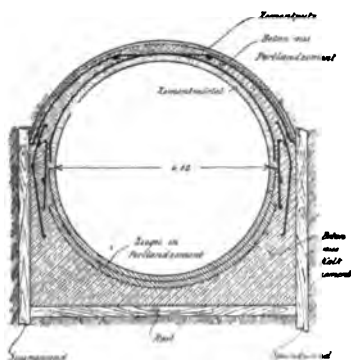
Hauptkanal in Cleveland, Nordamerika. 1 : 150.
